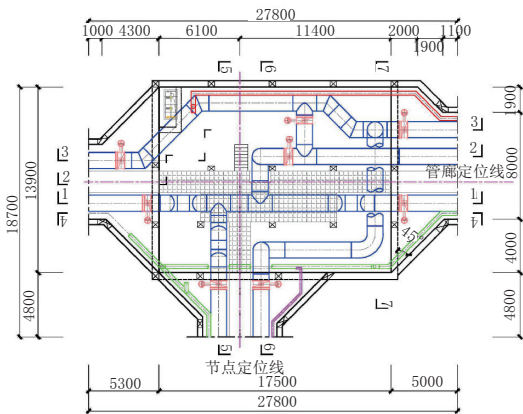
T形立体交叉节点供冷管平面布置图(单位:mm)
